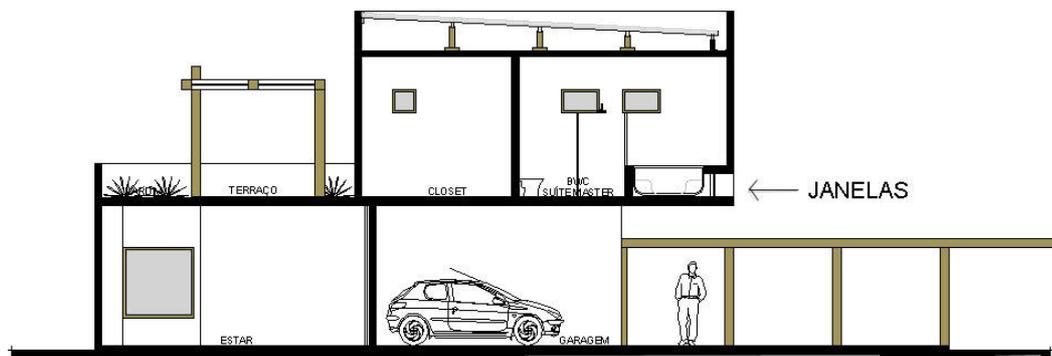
Corte transversal (passando pelo conjunto de janelas baixas)
